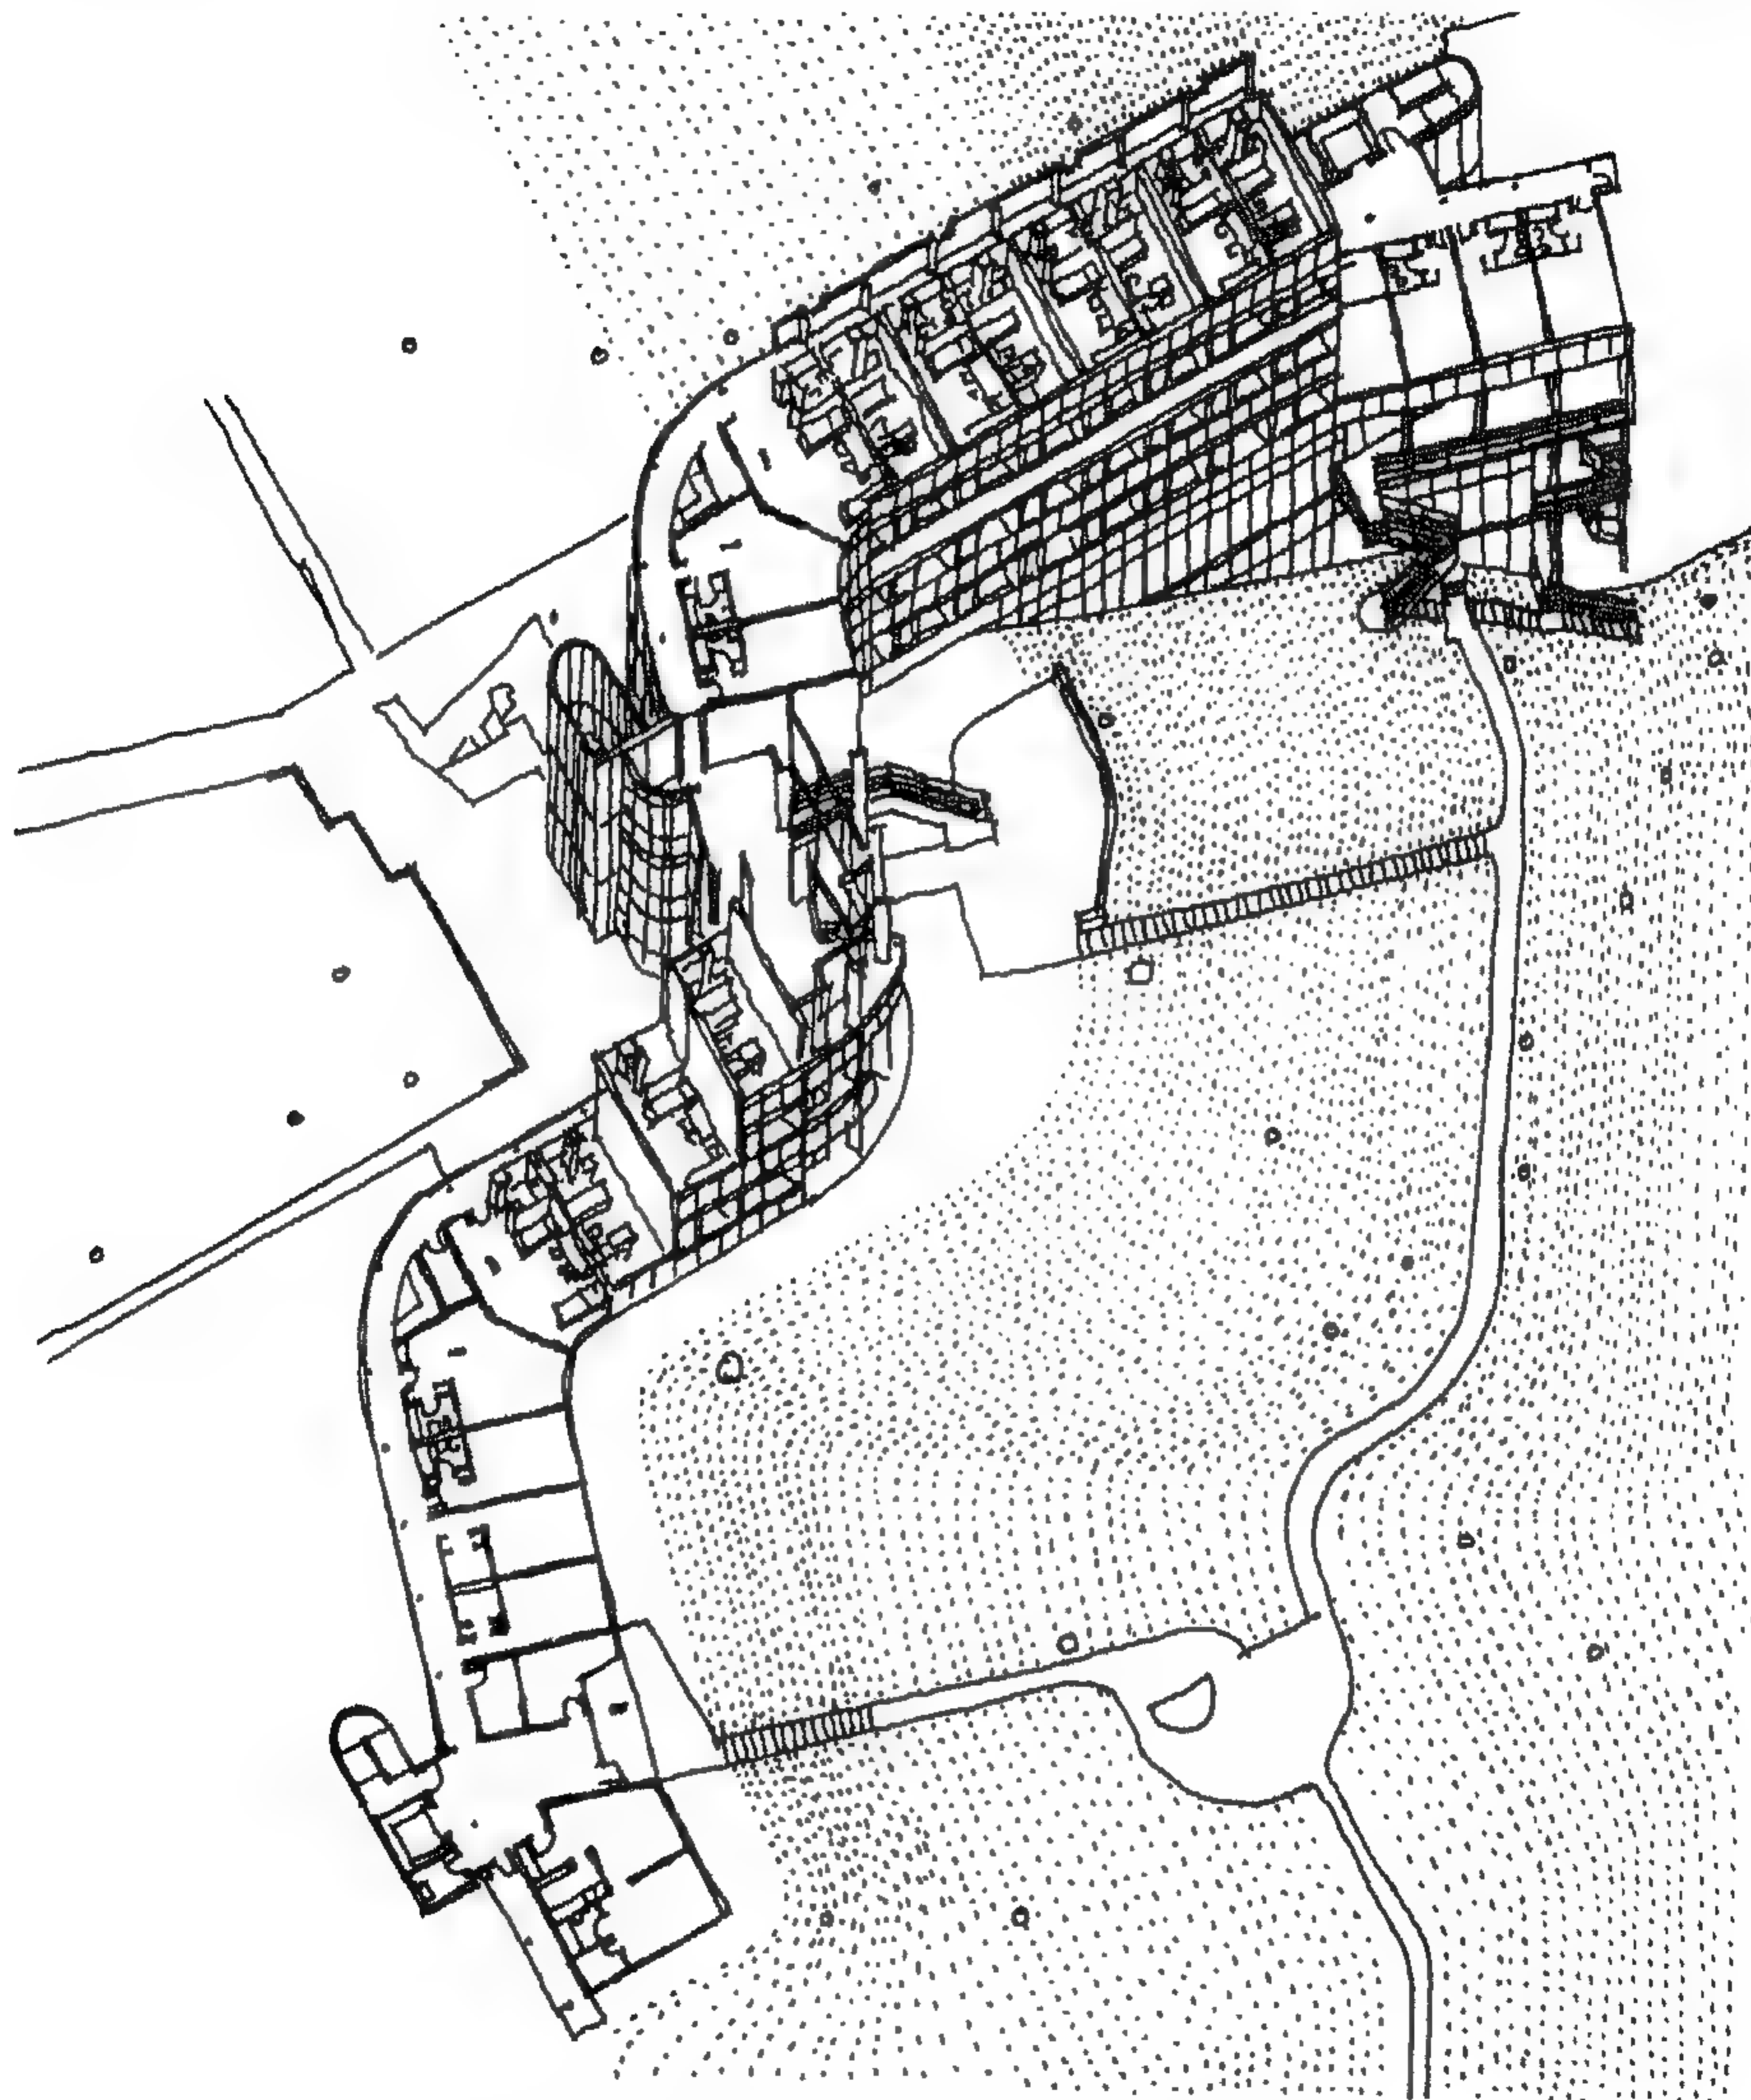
مخطط أفقي للدور الأرضي والمتكرر لمبنى سكن الطلاب بمعهد MIT
